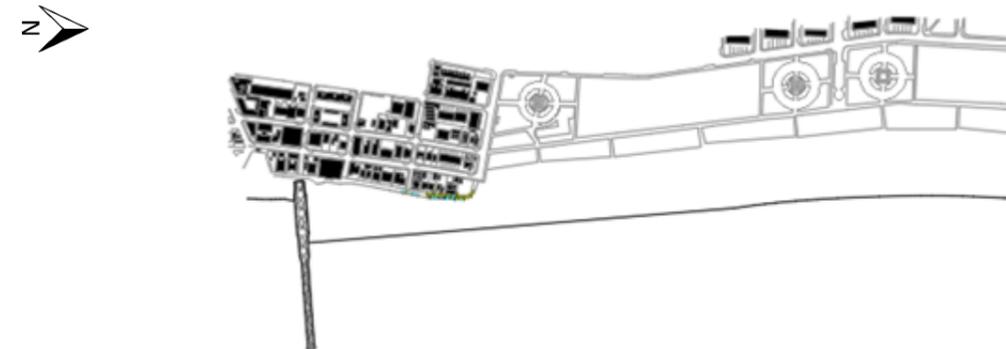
Forma en planta de la alternativa 2: espigón semisumergido. Fuente: Elaboración propia.
